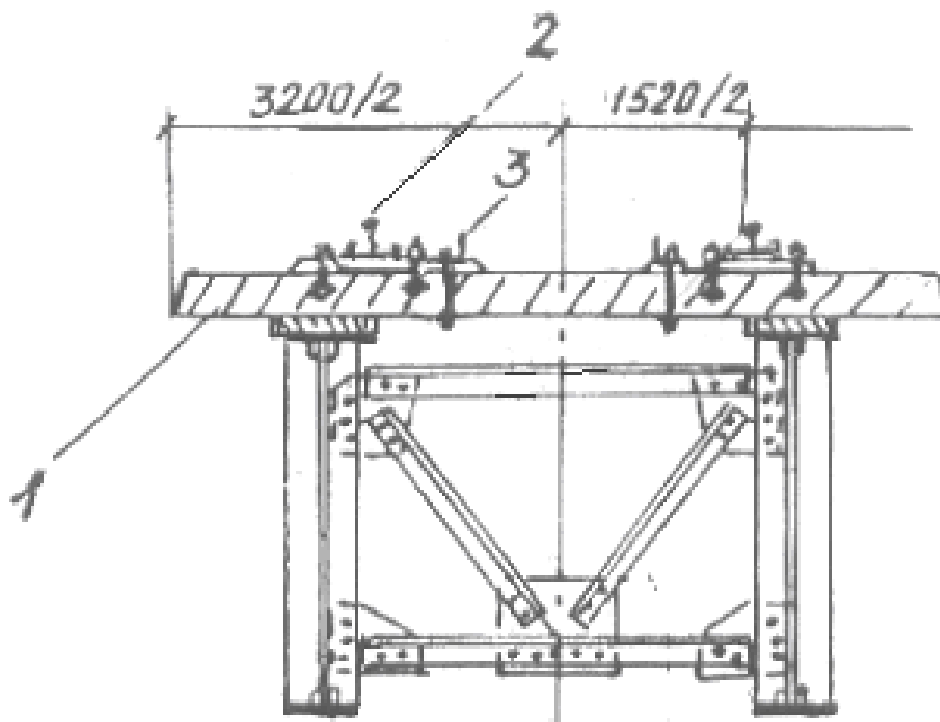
Мостовое полотно с безбалластной железобетонной плитой (Россия): 1 – железобетонная плита; 2 – рельс; 3- контруголок (перила и тротуар не показаны)
